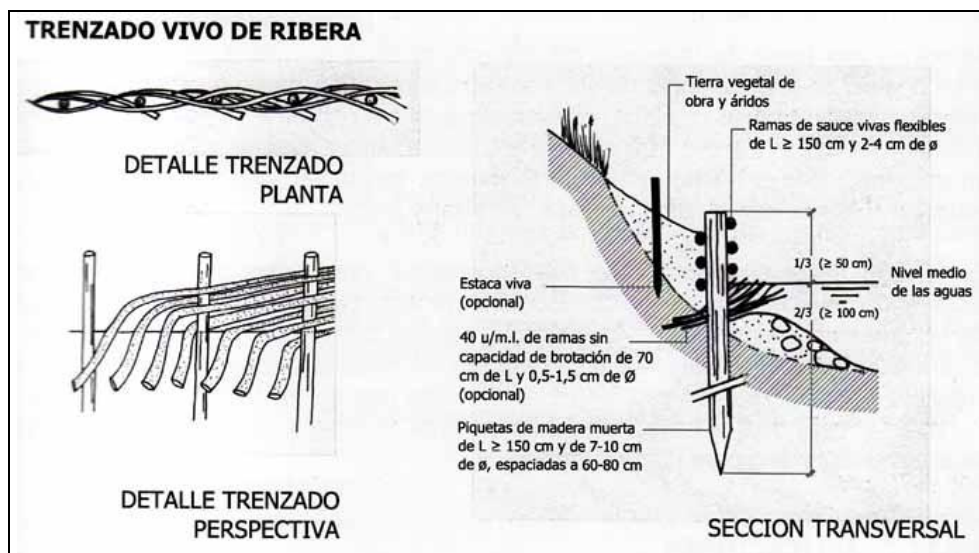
Detalles constructivos de trenzado vivo. Fuente: NTJ 12S Parte 5, año 2010.
